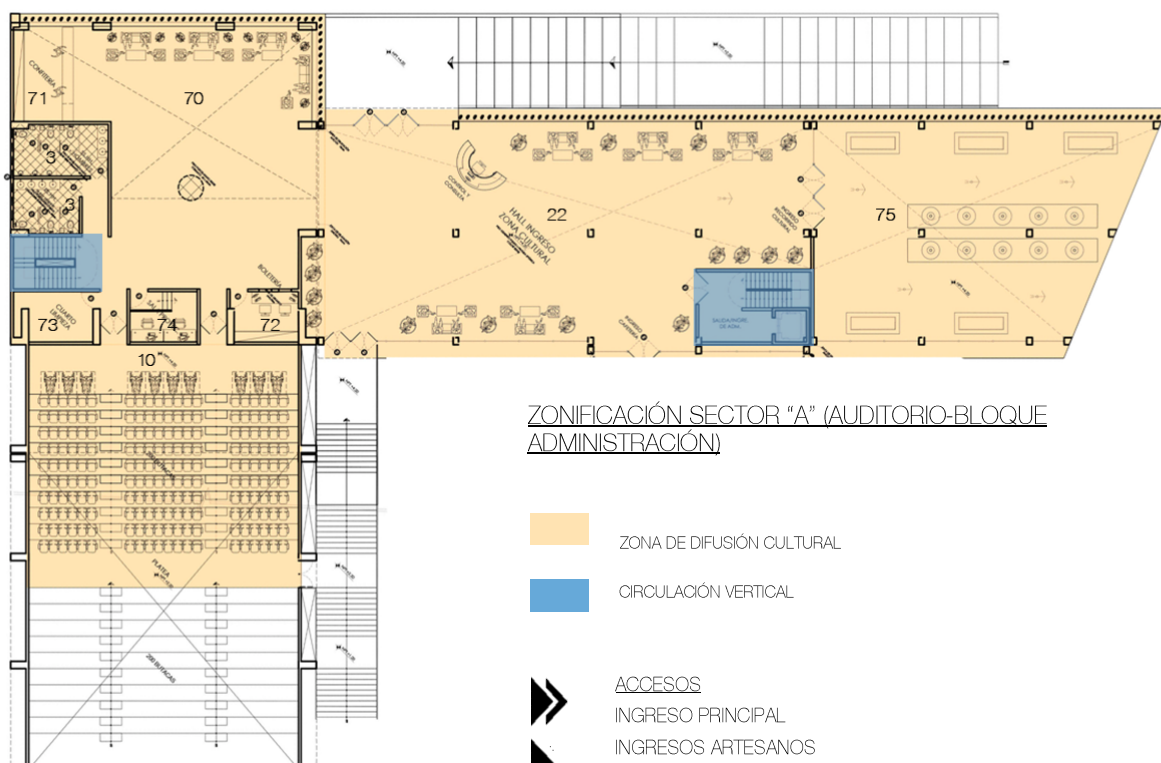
Planteamiento de Zonificación en planta
